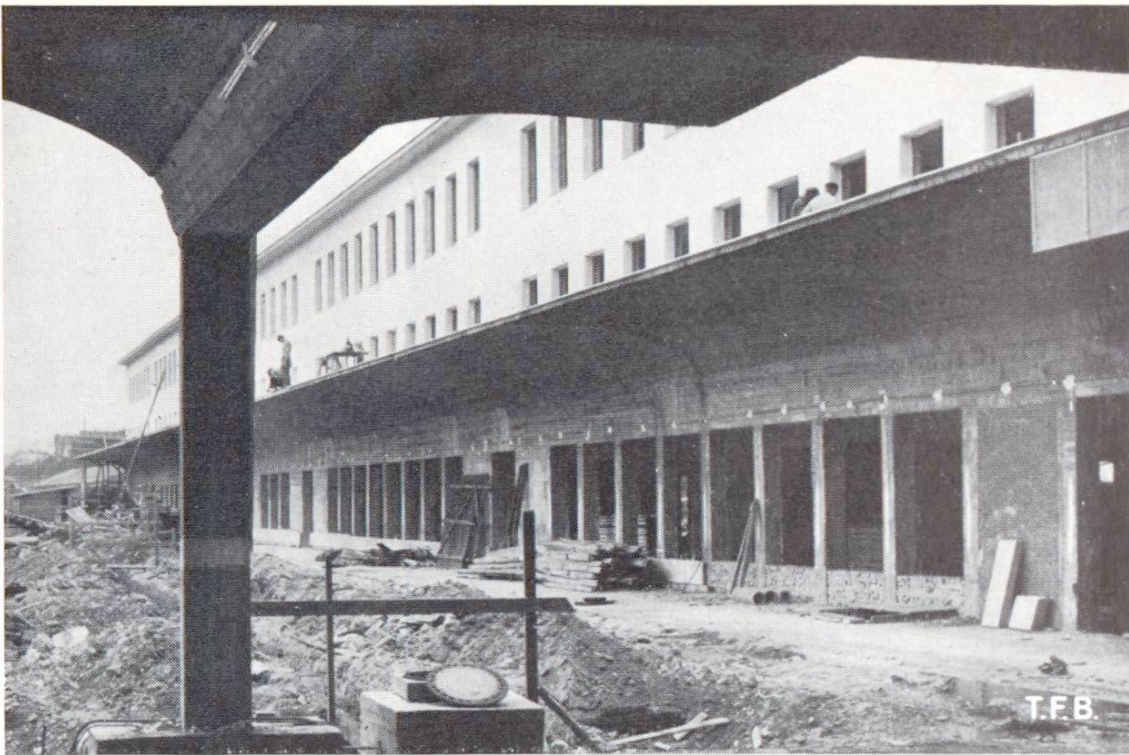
Bahnsteig-Vordach entlang dem Restaurations- und Bürogebäude. Das fertige Dach wird mit einer Randabdeckung aus Blech und mit einer Asphalt-Dichtungsschicht versehen
